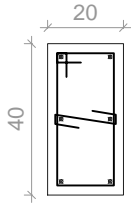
Detalhamento da Viga V07 no projeto com drywall
